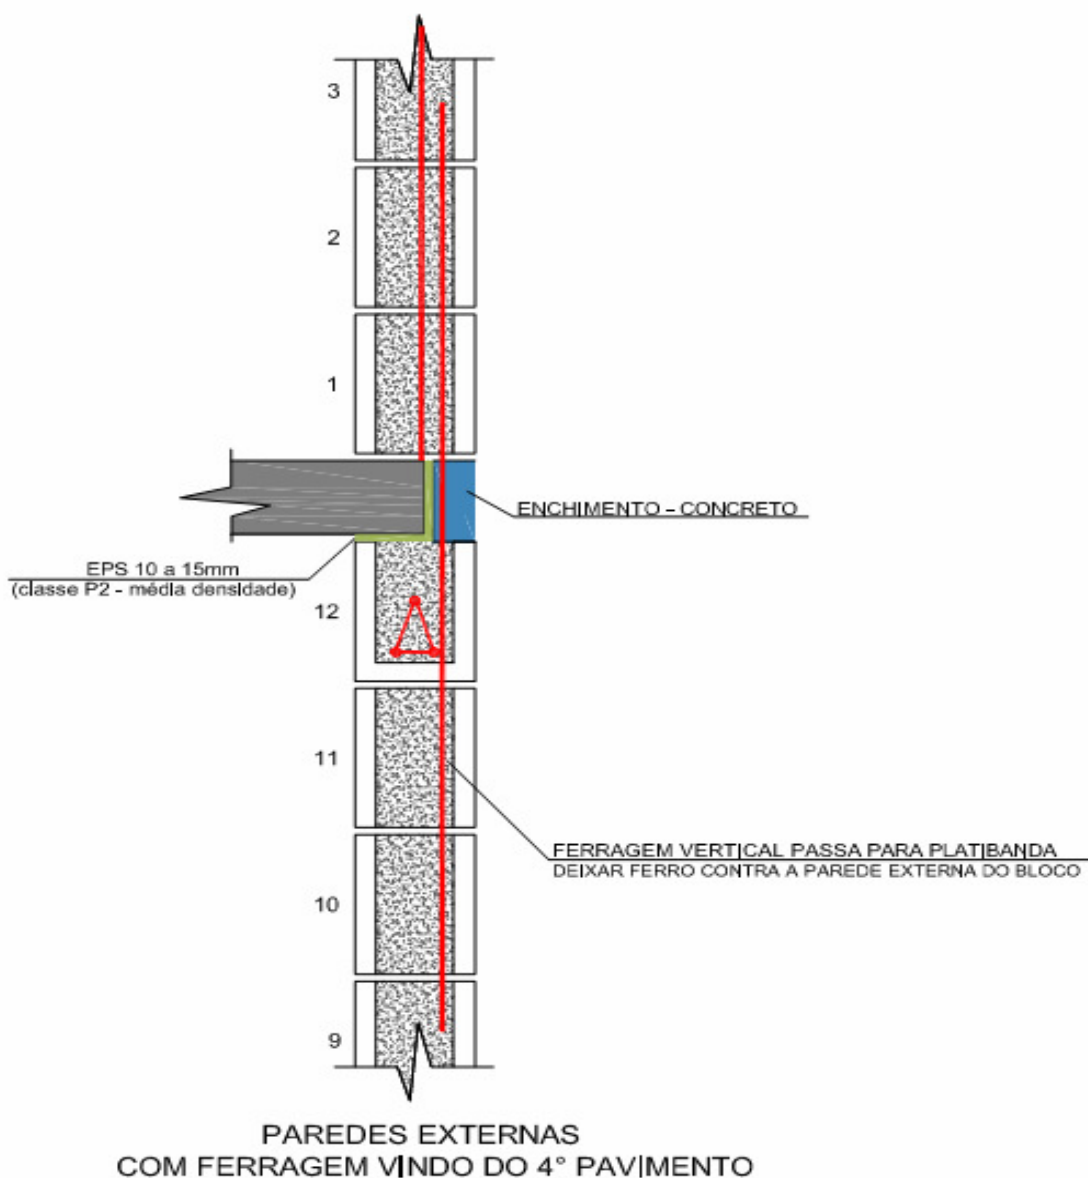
detalhe do apoio das lajes pré-fabricadas em paredes externas com ferragem vindo do 4º pavimento
